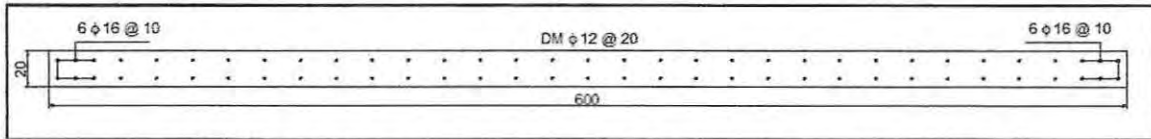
Armadura de flexo-compresión Muro 1, Estructura III (Aislada).
